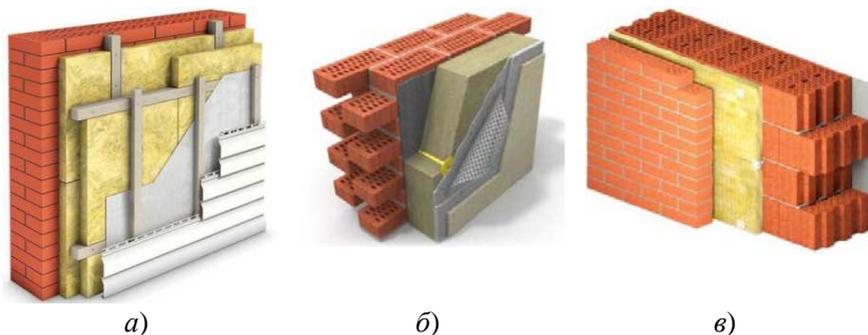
Способы теплоизоляции неутепленной стены
